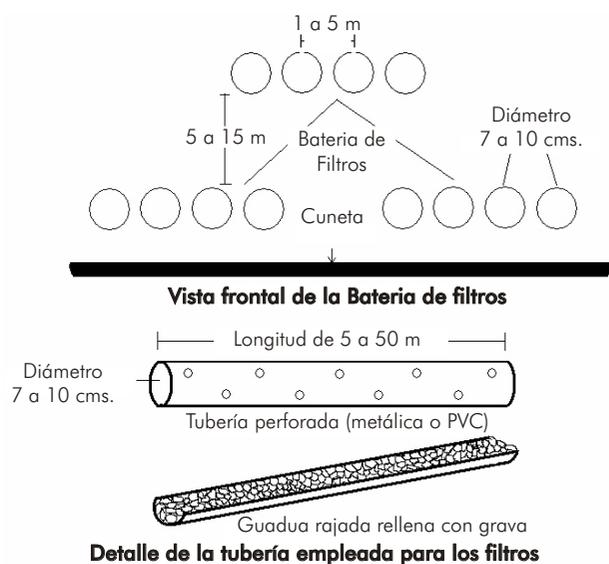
Sistema de sangría mediante batería de filtros.
